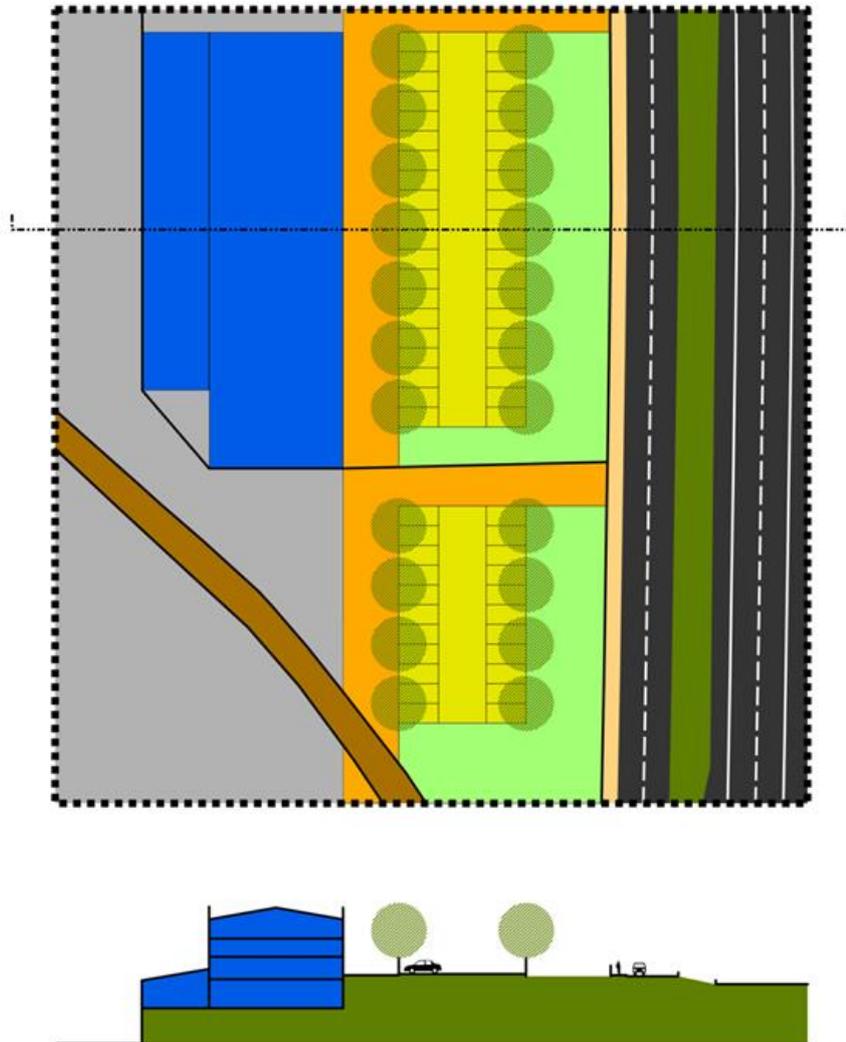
Ações e orientações estruturantes (Pormenor e perfil)
